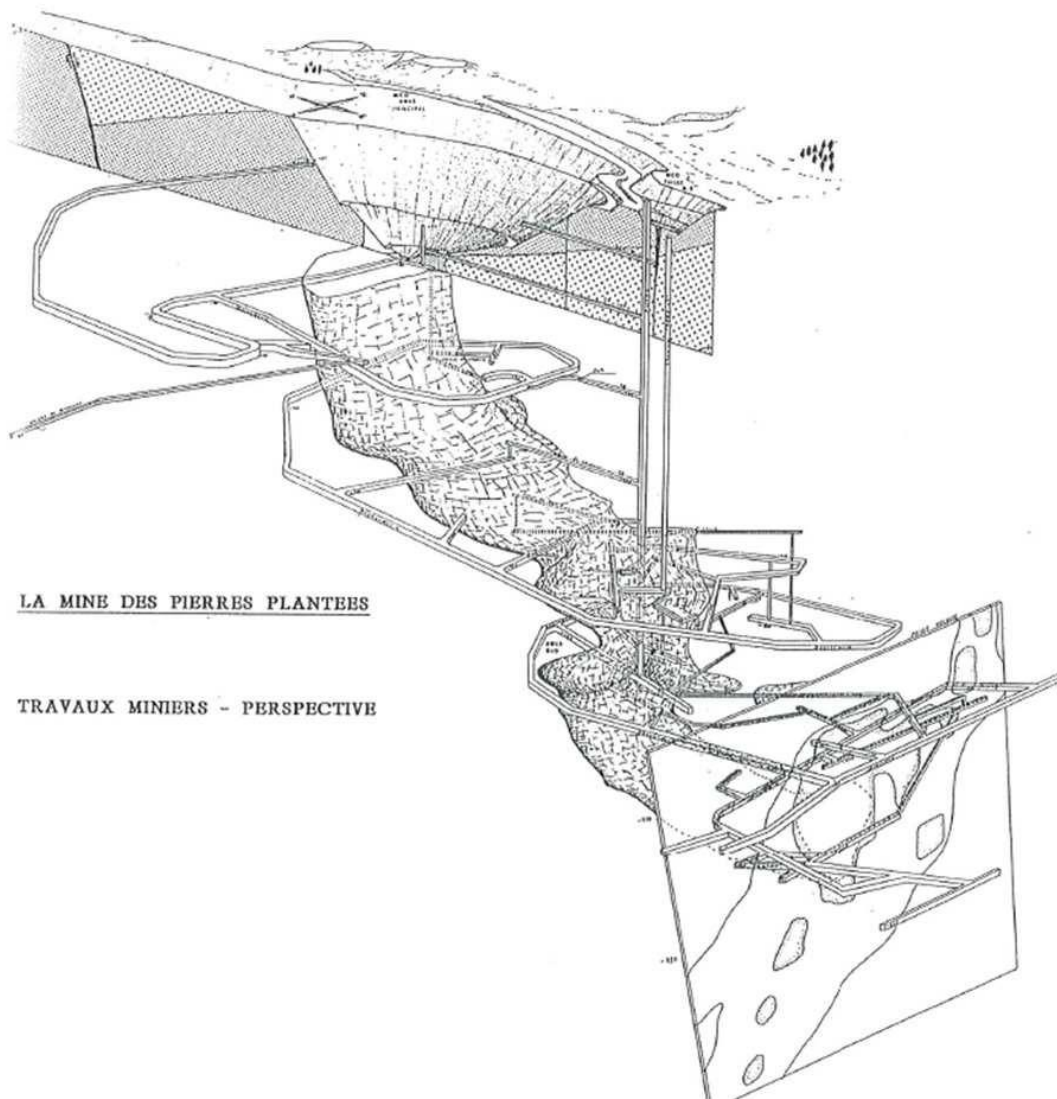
Schéma des travaux miniers réalisés sur le site Les Pierres Plantées (source Areva [3])
